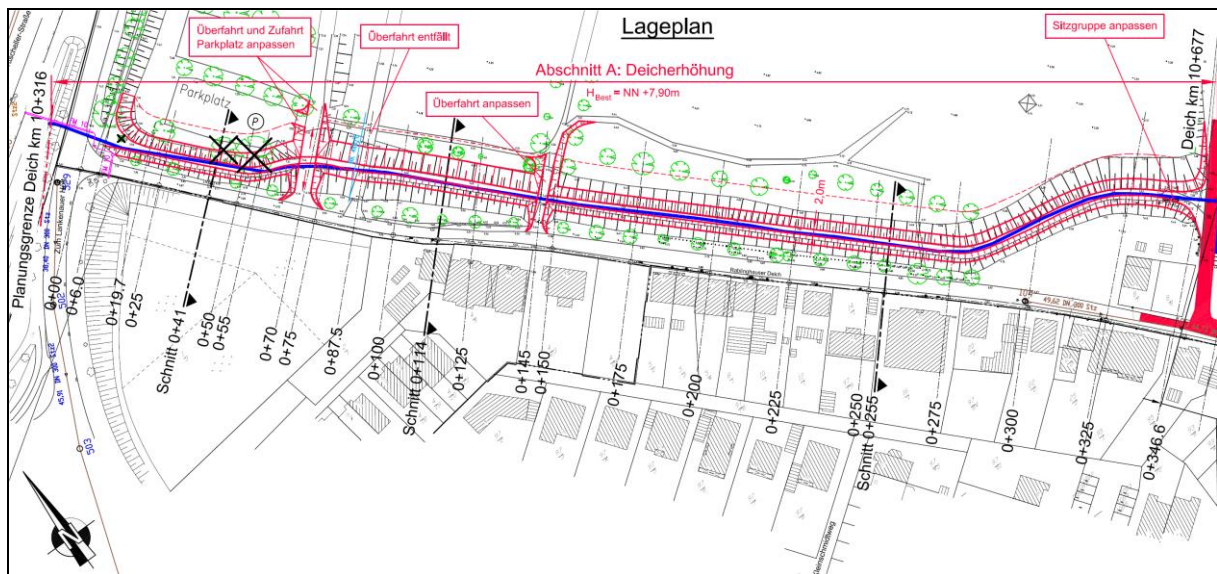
Rahmenentwurf Abschnitt A - Ausschnitt Lageplan (IL 2013)
